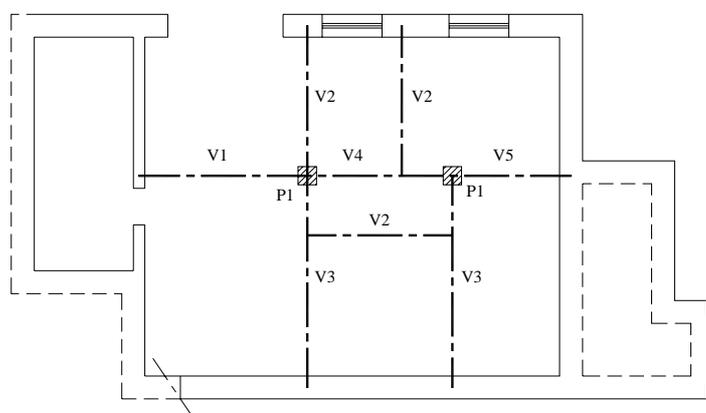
Planta da garagem (semi-enterrada) de uma moradia isolada, com 2 pisos elevados e com pilares e vigas em betão armado no interior.
